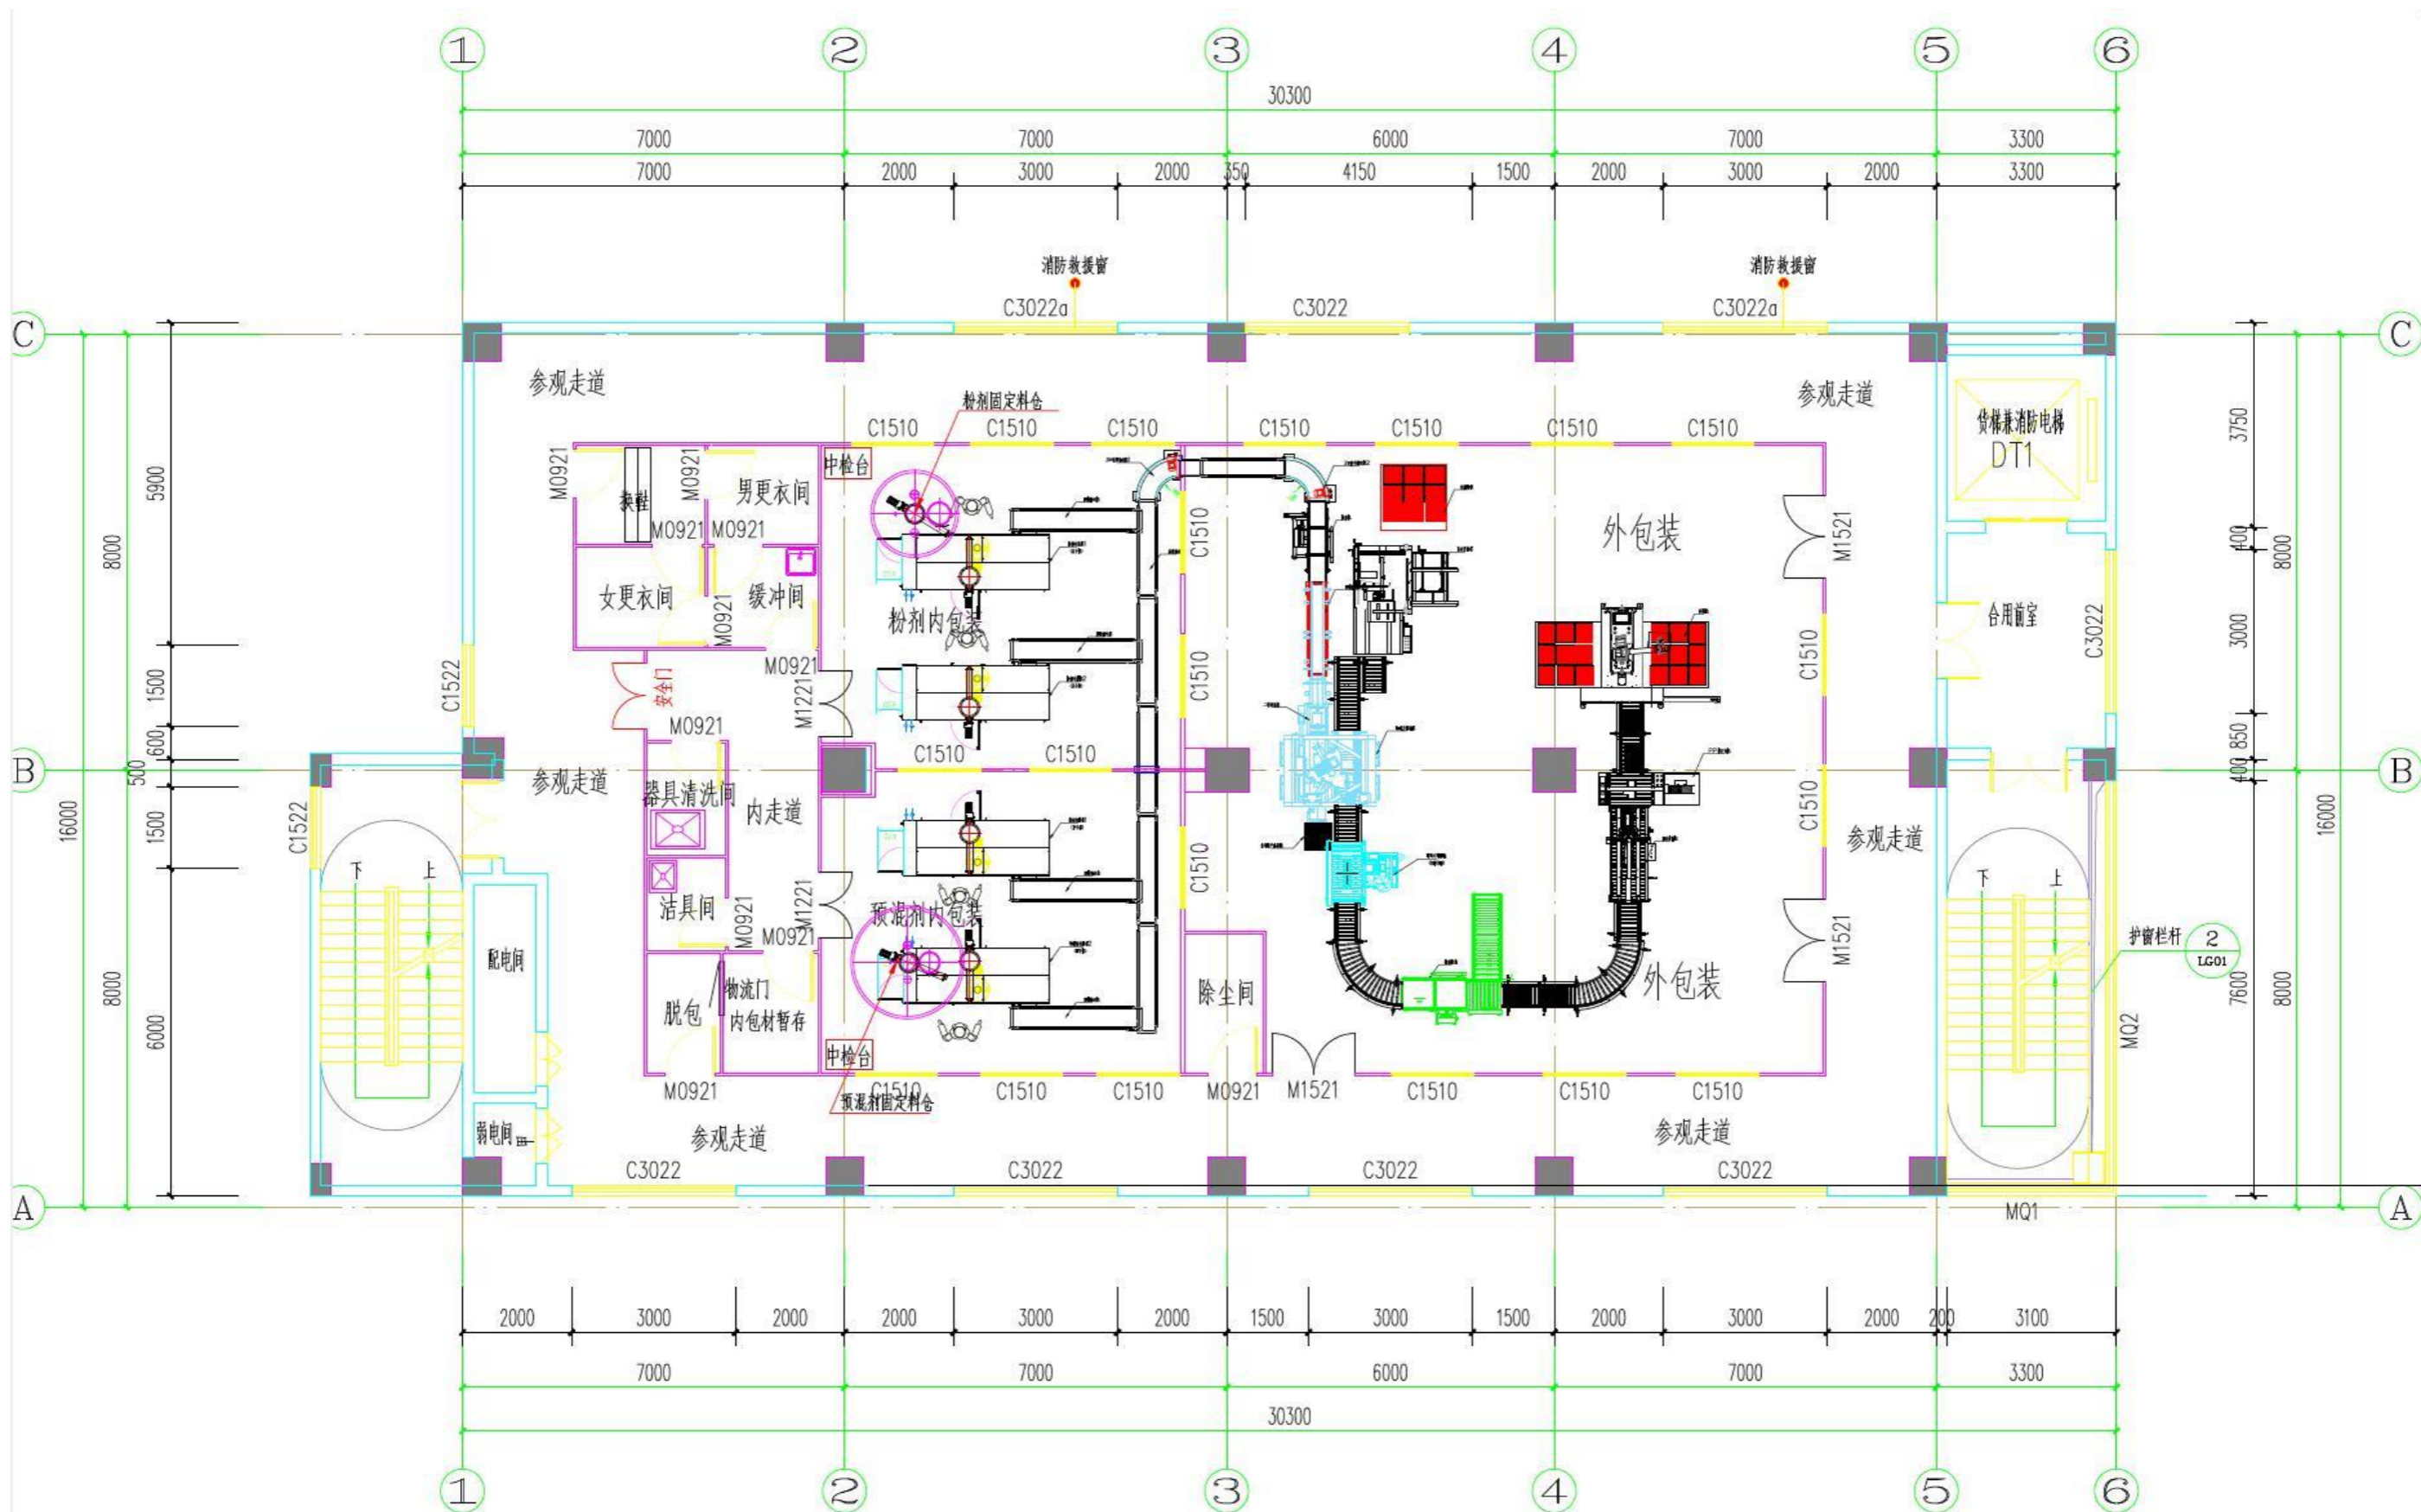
五层（粉剂、预混剂车间）平面布置图（比例尺 1:100）
